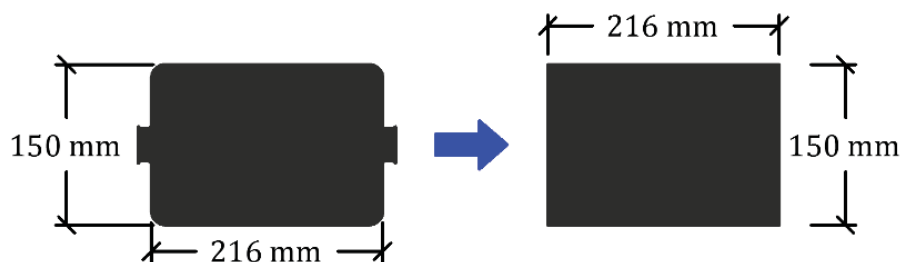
Simplificação de cálculo relativa à área do núcleo de betão armado
